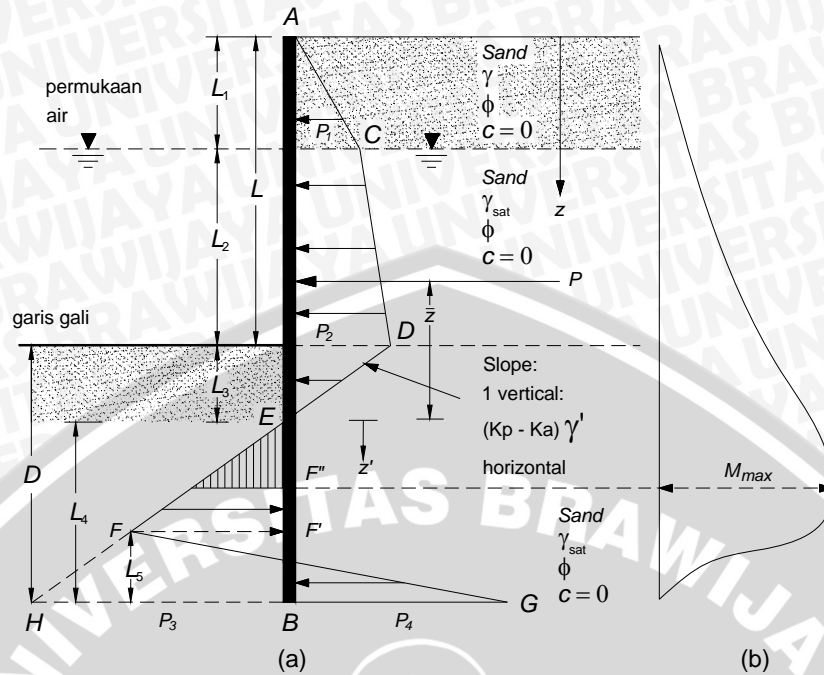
Tekanan tanah pada *cantilever sheet pile
